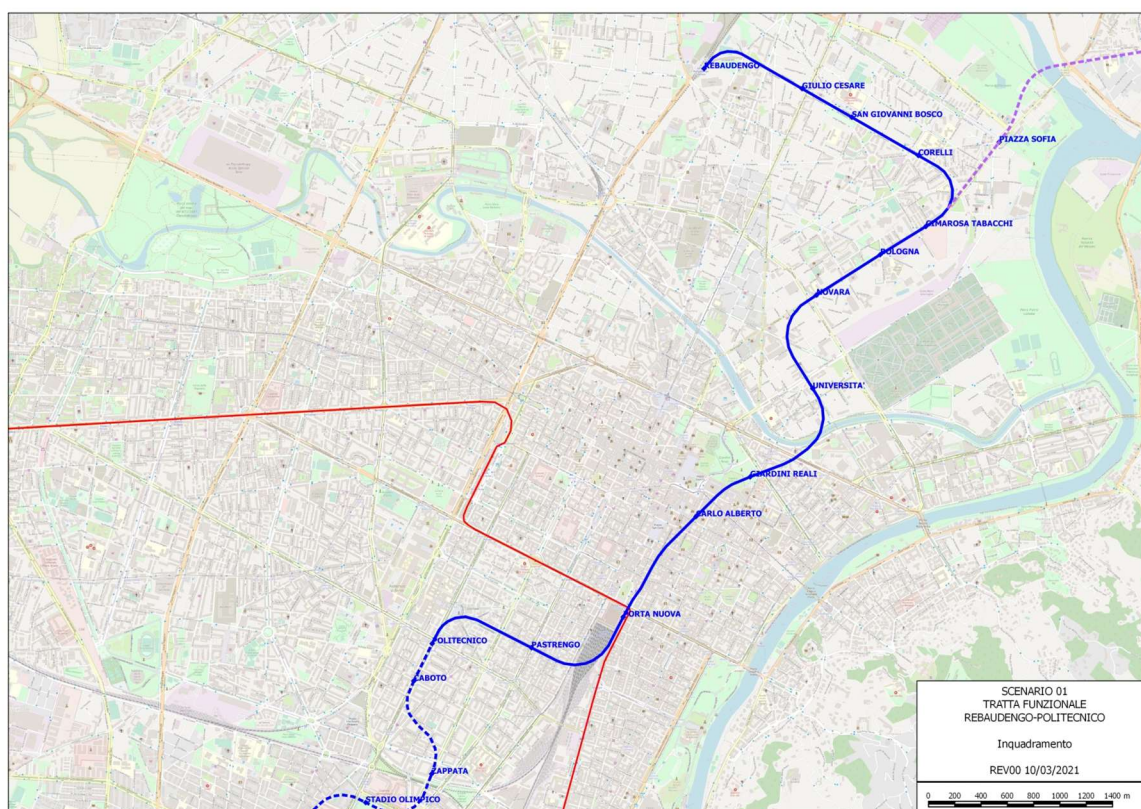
Key-plan della linea 2 – Lotto funzionale 1 – Rebaudengo - Bologna
